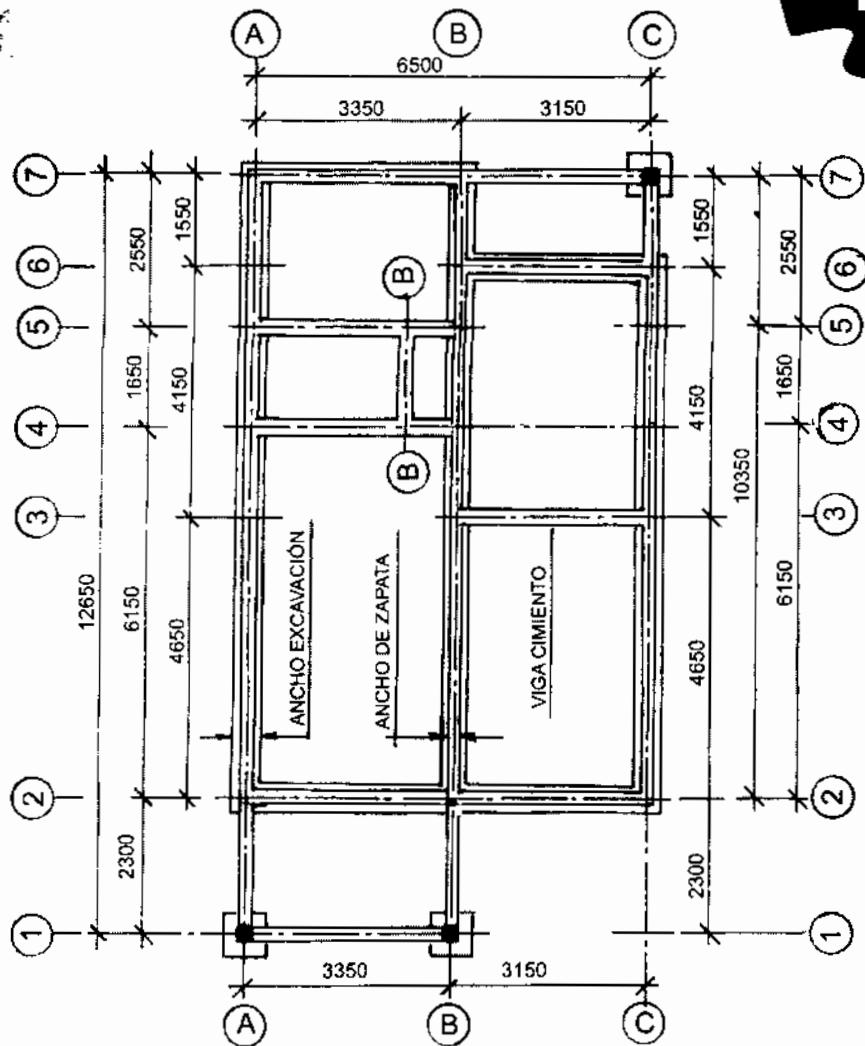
C ESQUEMA DE PLANTA CIMENTACIÓN CORRIDA
